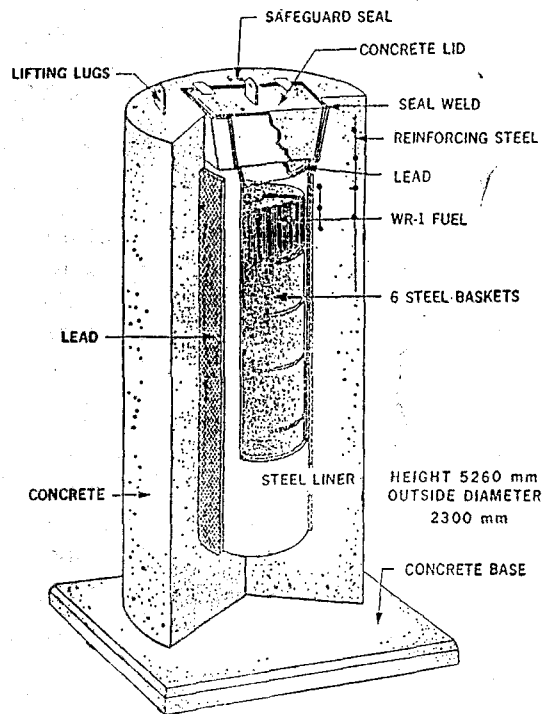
使用後 核燃料 貯藏用 Concrete Silo
